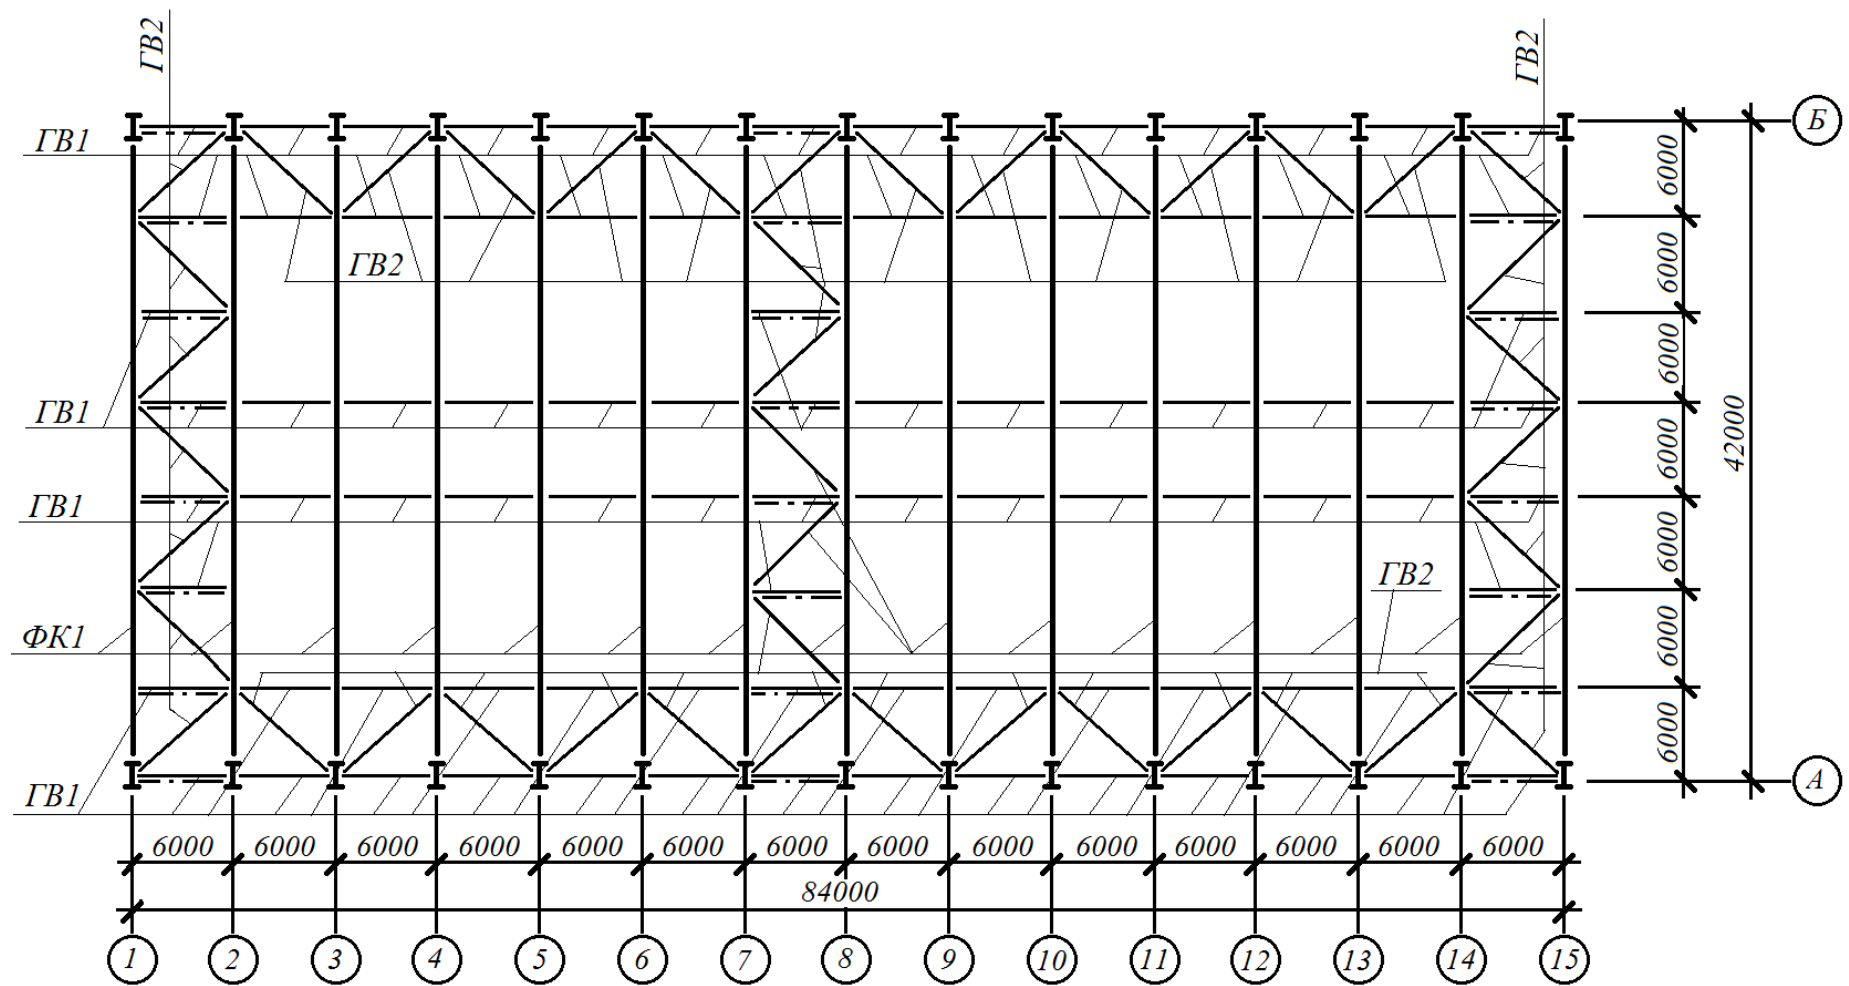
План в'язей по нижніх поясах кроквяних ферм.
